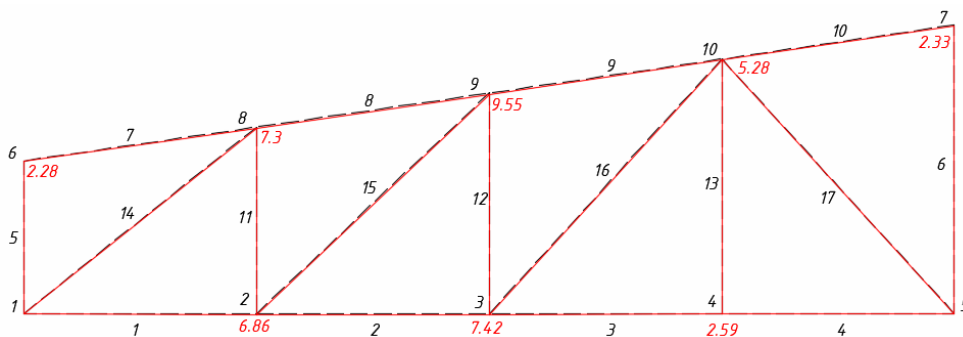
Перемещения узлов фермы, мм, вариант №2
